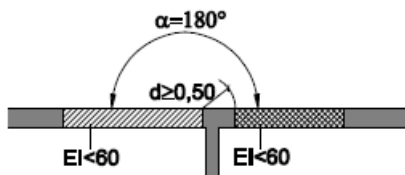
Fachada a 180°. Fuente: Código Técnico de la Edificación.
